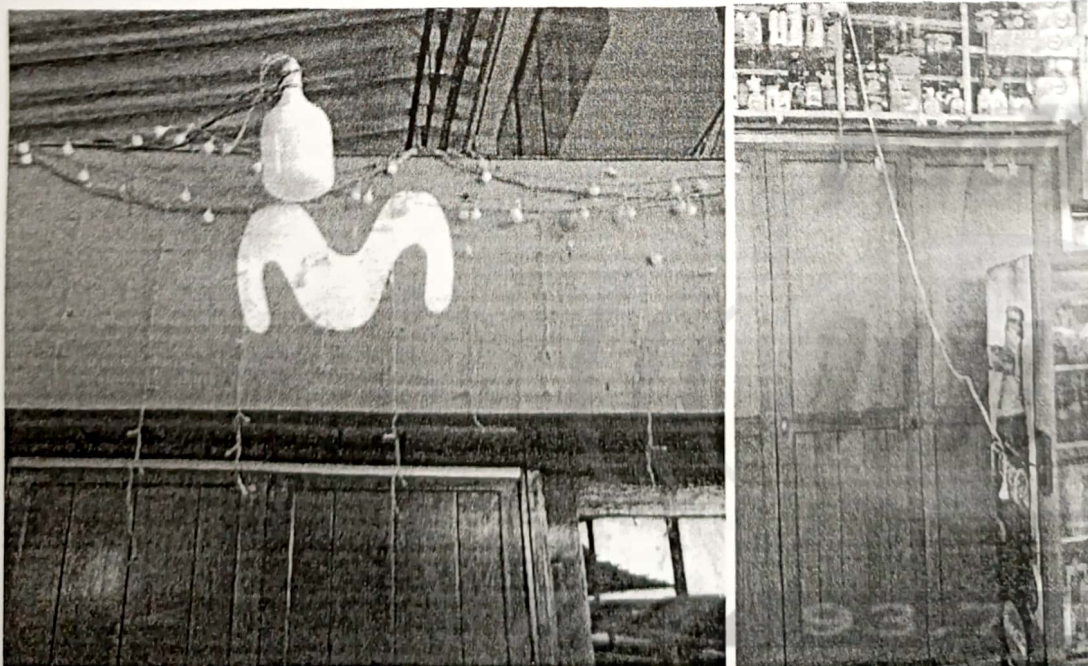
Al exterior de módulos de venta, se observa cables mellizos expuestos.
